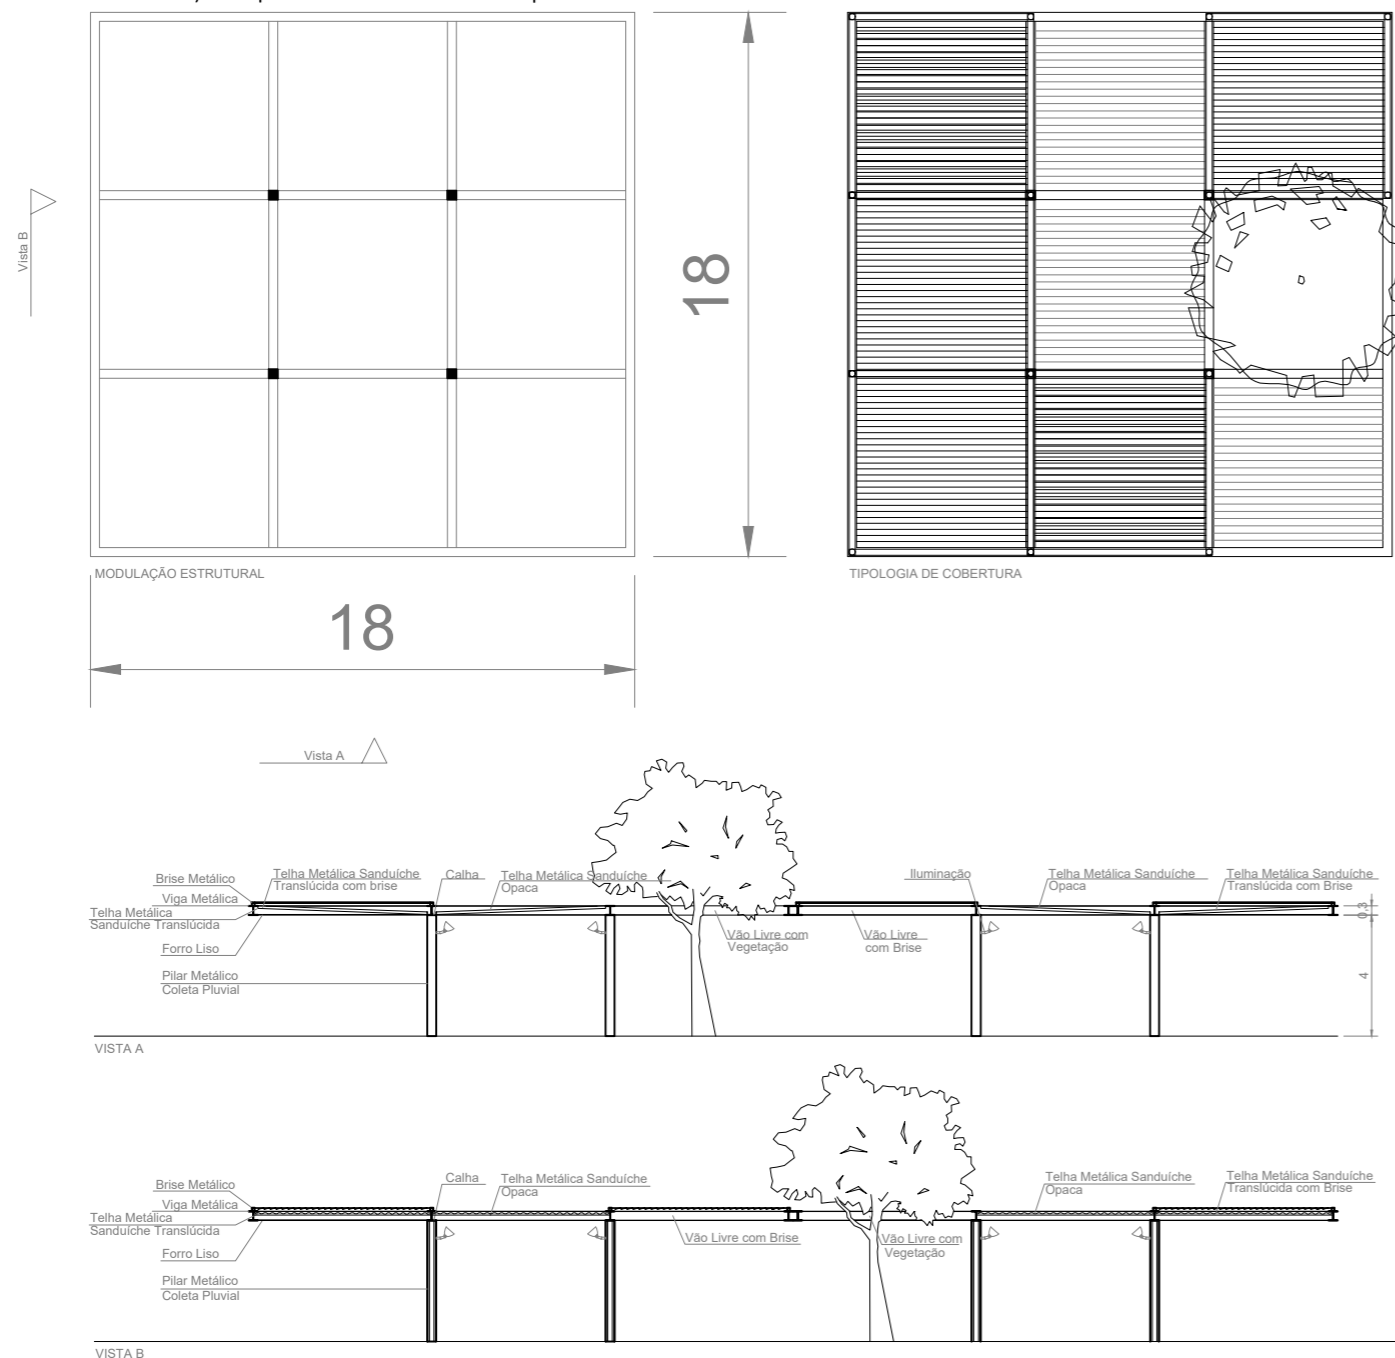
Esquema estrutural da cobertura metálica independente 1:250
